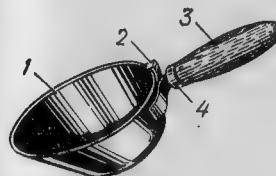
1 — чаша; 2 — пластина-крючок; 3 — ручка; 4 — колпачок
